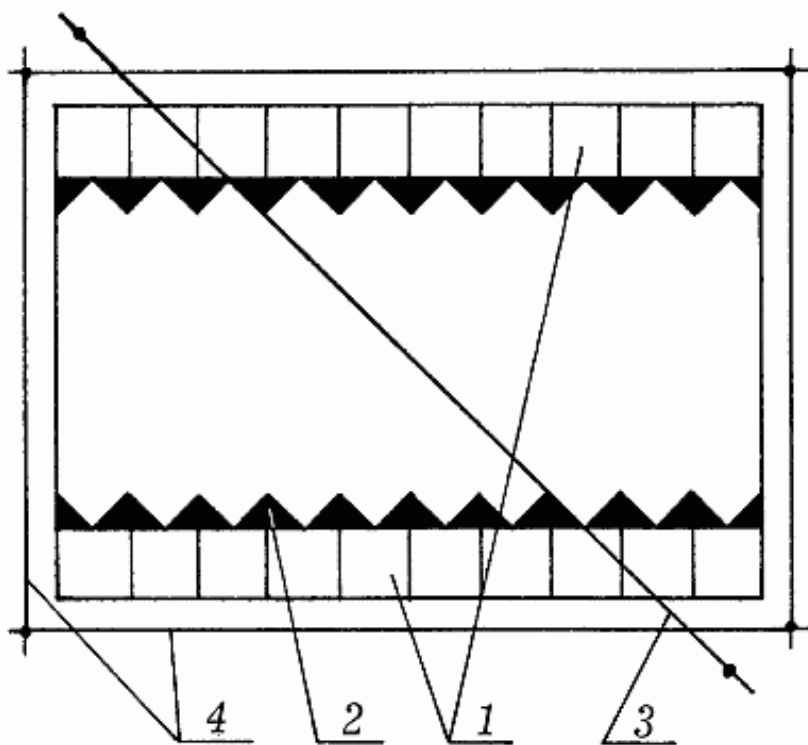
Облицовка стены по диагонали: 1 – прямой верхний ряд; 2 – треугольные плитки; 3 – шнур-причалка при укладке плитки наклонными рядами; 4 – шнуры-причалки при укладке плиток горизонтальными рядами
